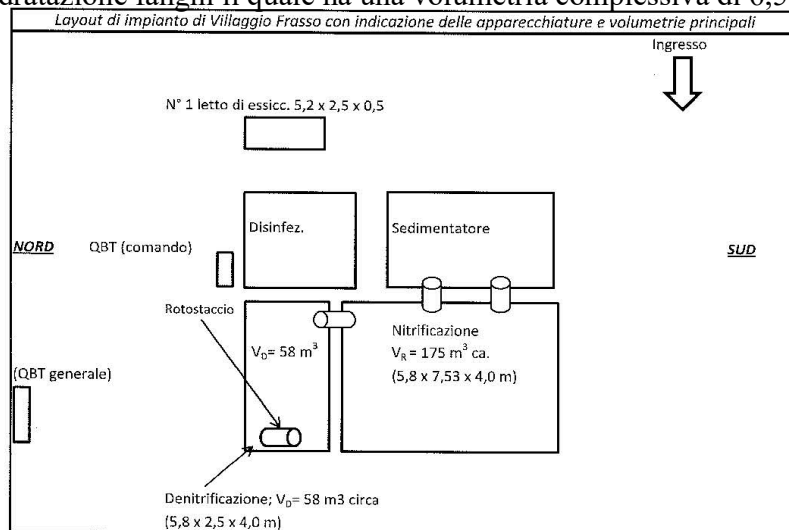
Layout esplicativo dell'Impianto di Villaggio Frassa con indicazione delle apparecchiature e delle
